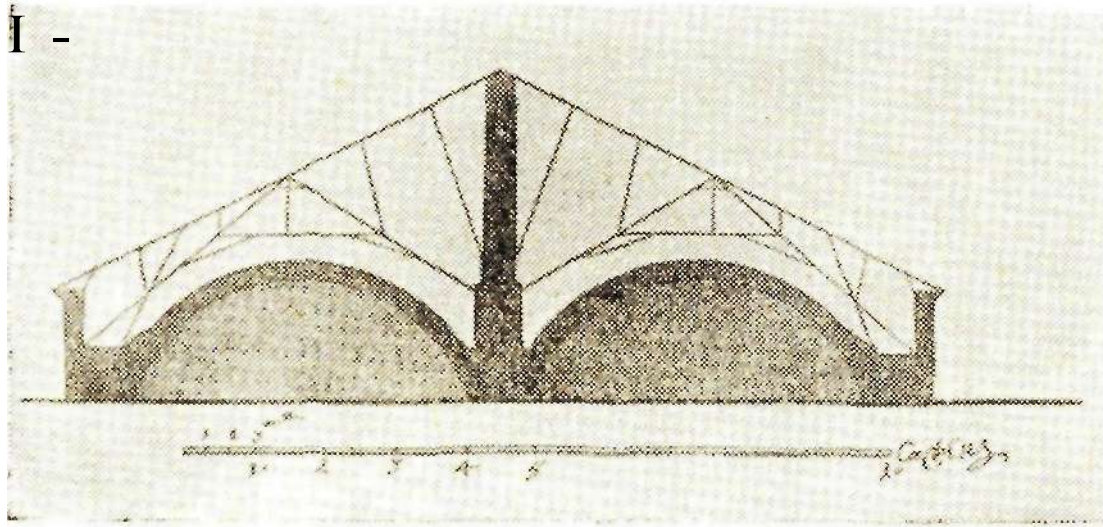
Железная конструкция перекрытия над зданием Вотчинной коллегии (конец XVII в.)
